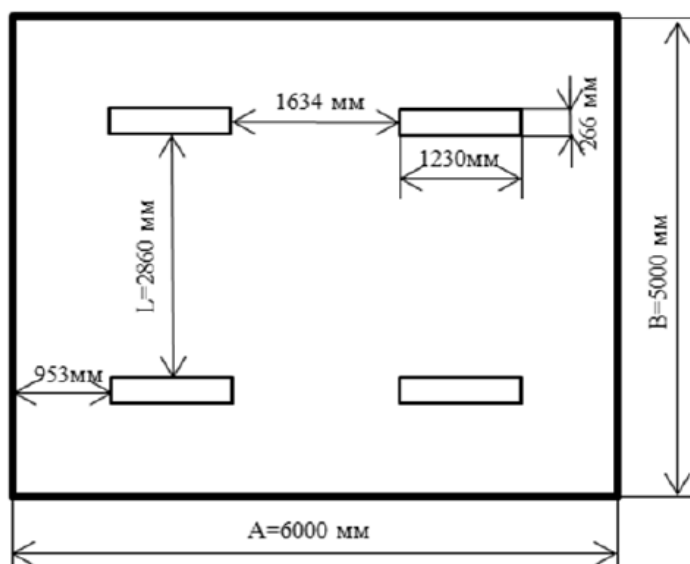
План помещения и размещения светильников с люминесцентными лампами.
